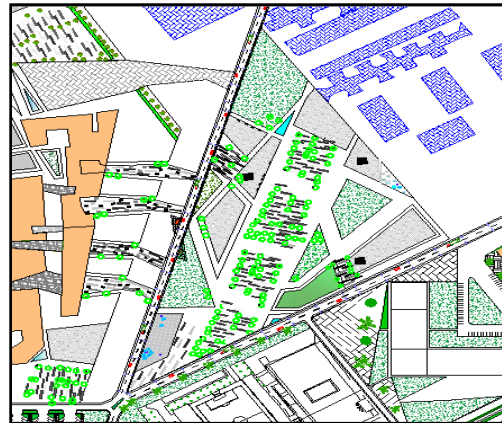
Vue en plan de la placette centrale (plan vert) après l'intervention
